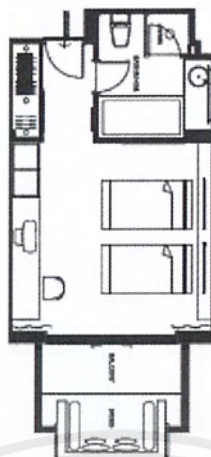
แสดงผังห้องแบบ Plantation view
